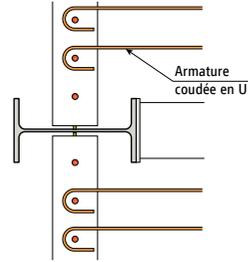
Fonctionnement d'un assemblage mixte poutre-poteau
